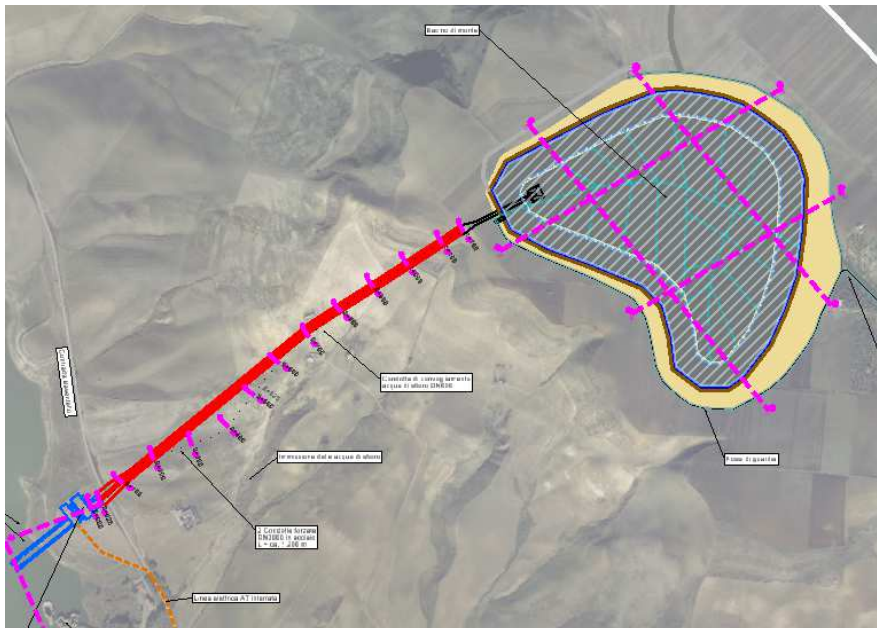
Estratto della planimetria di progetto di cui all'Elaborato PD-EP.13.
